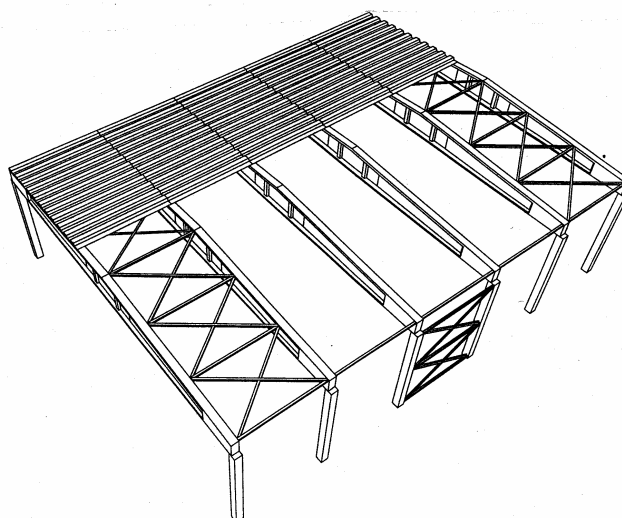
Diagonais de aço para contraventamento da cobertura ou de estruturas da fachada.
